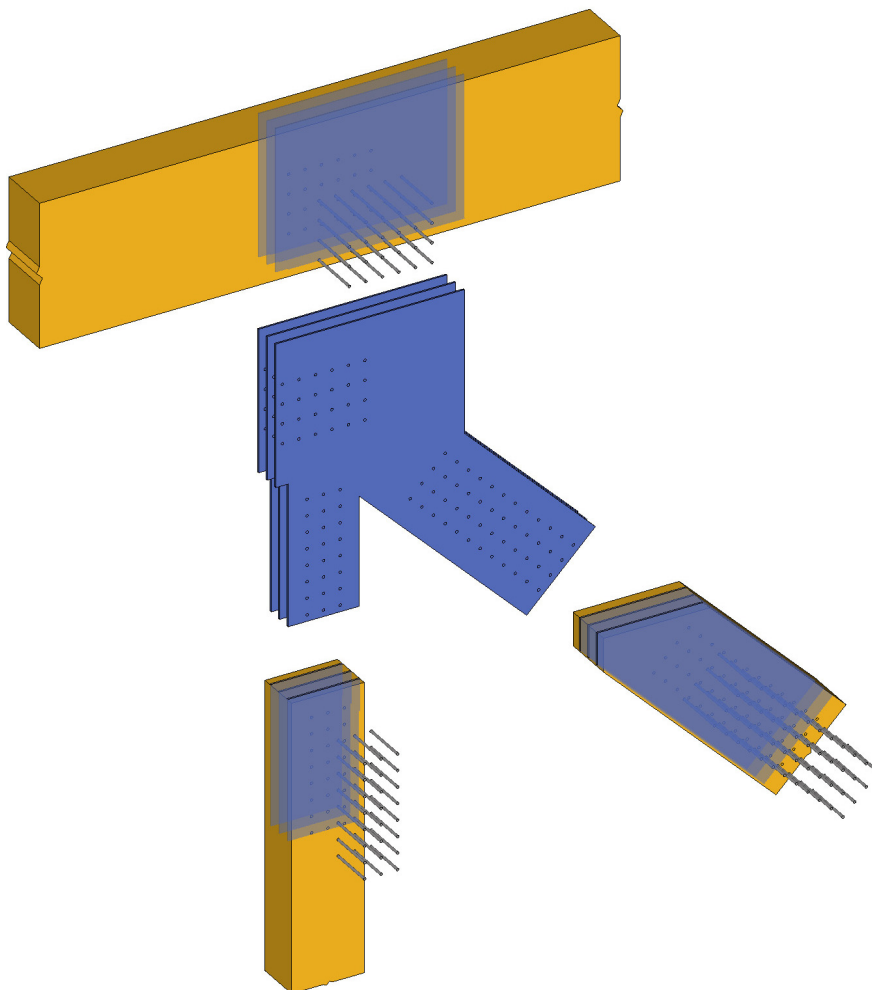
Explosionszeichnung des Anschlusses für Fachwerk FA3.j
